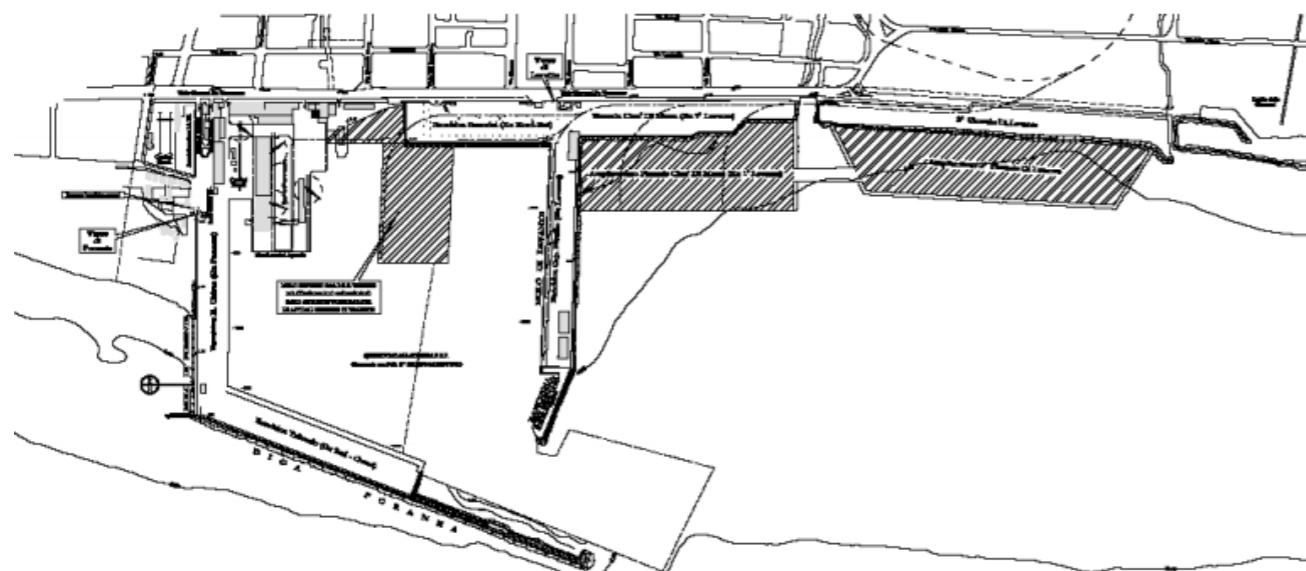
Planimetria del PRP del 1981 (AdSP)
